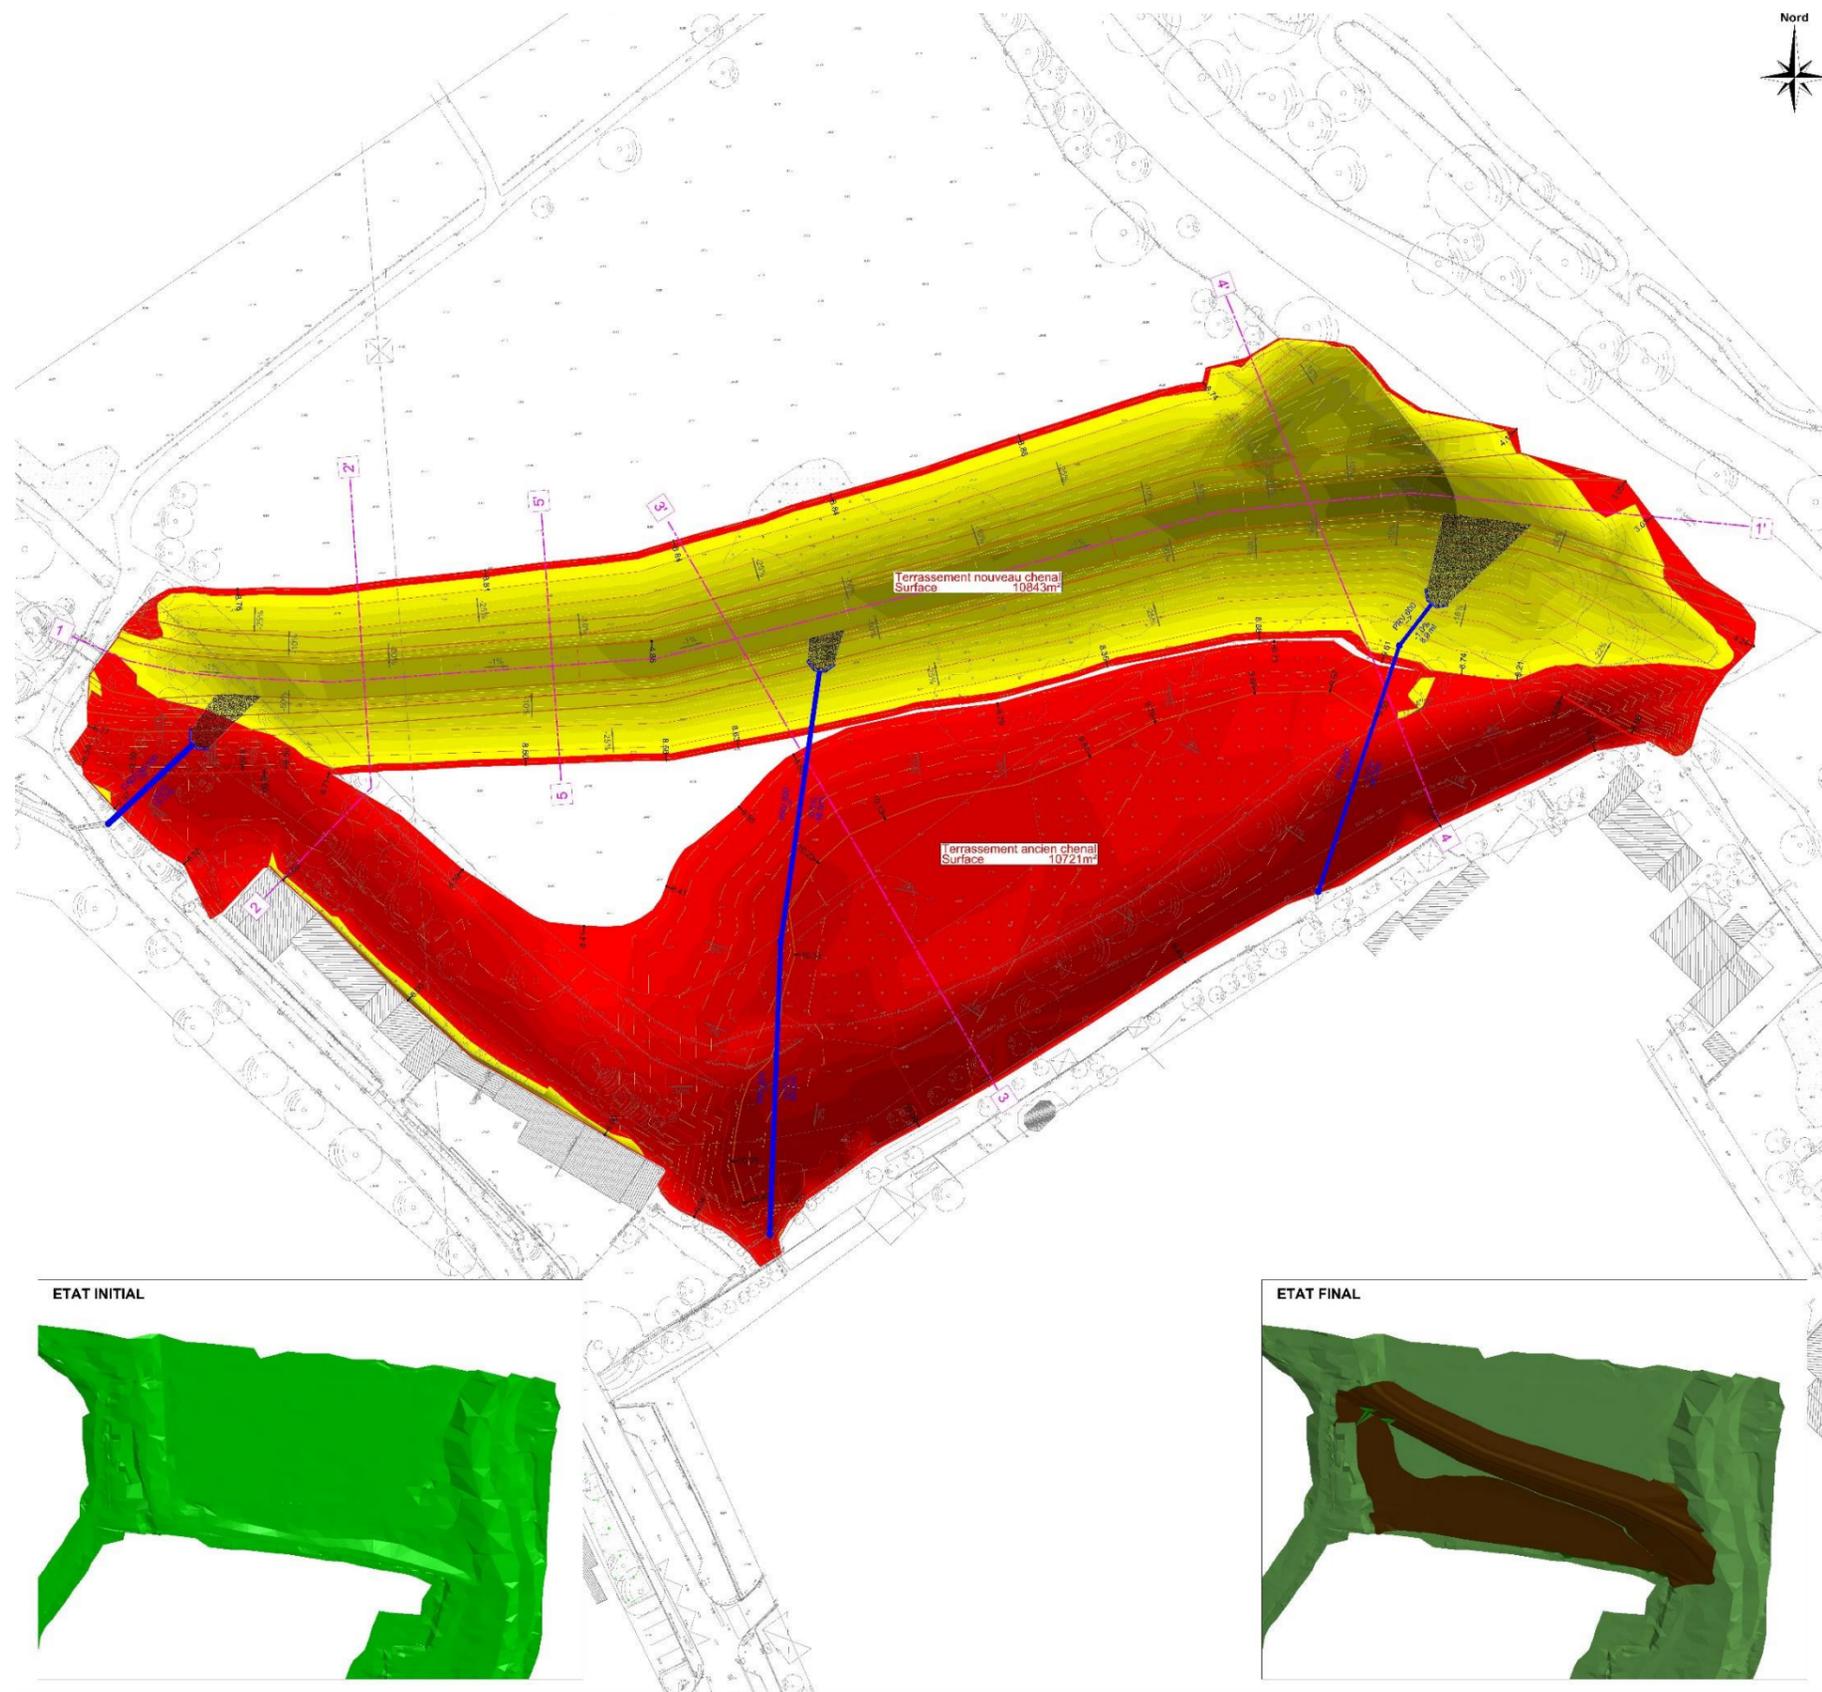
DEVIATION DU CHENAL – VUE EN PLAN – PLAN DE MASSE (EGIS, 2023)
